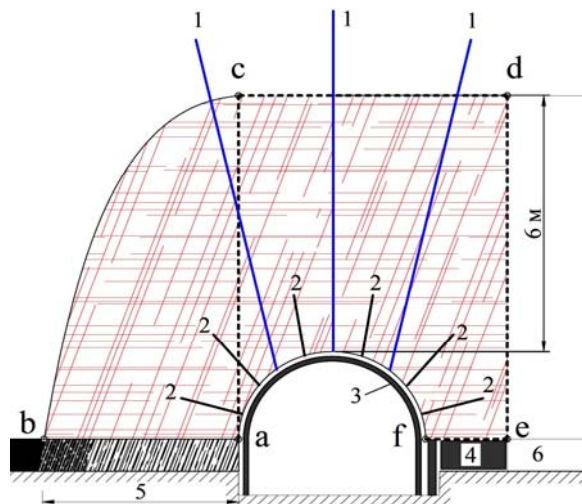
Схема нагрузки на крепь выработки за очистным забоем и рекомендуемая схема установки канатных анкеров: 1 – канатный анкер; 2 – штанговый анкер; 3 – рамная крепь; 4 – охранная конструкция; 5 – ширина зона разрушения краевой части пласта (Zabolotnaya, 2015); 6 – выработанное пространство
